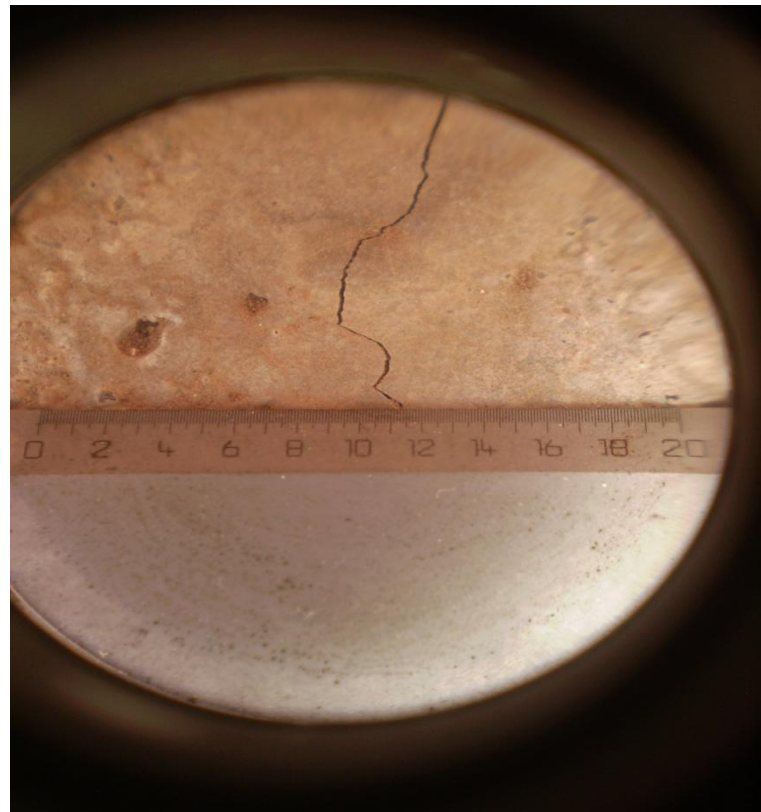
b Inspección ocular de las fisuras con instrumental (fisuras del orden de 0.1 milímetros).
